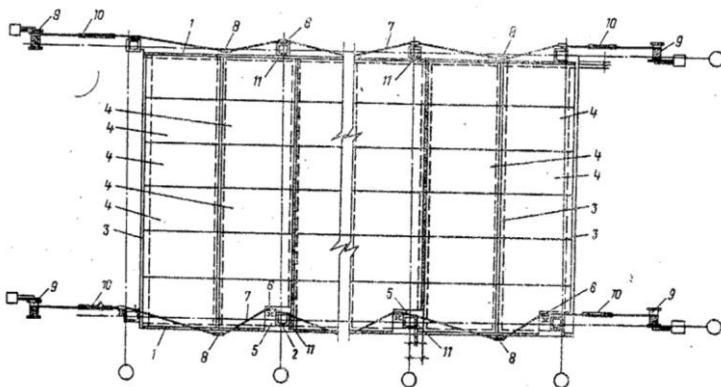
Укрупненный монтажный блок покрытия здания, вид в плане
